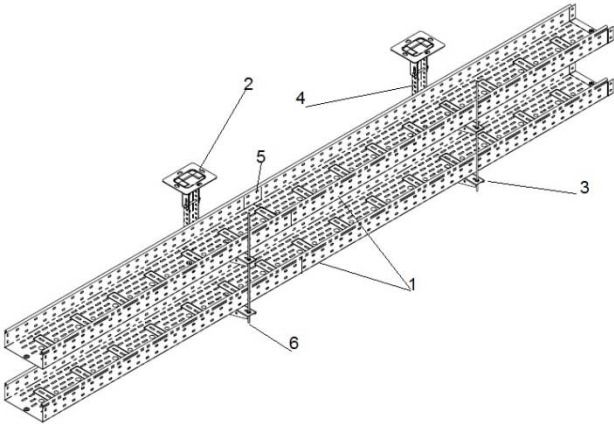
Общий вид сборного подвеса (таблица 40)
